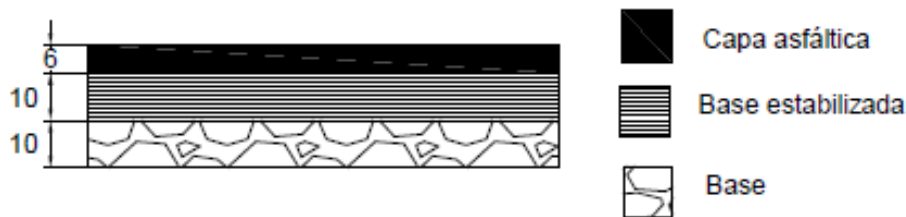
Espesores de pavimento realizado el 10 de julio de 2019 para el Tramo 25 (cotas en cm)
